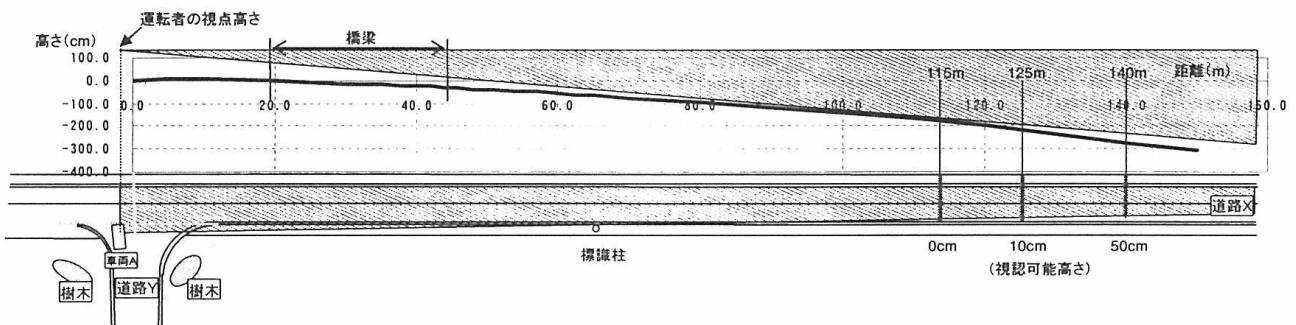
道路 X 進入直前位置からの視認範囲（下：平面図，上：縦断面図）
